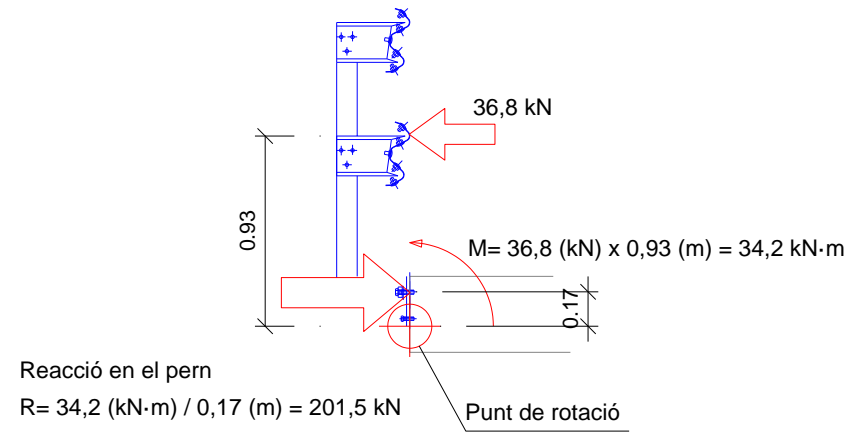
Anàlisi estructural en els ancoratges de la barana de protecció.
